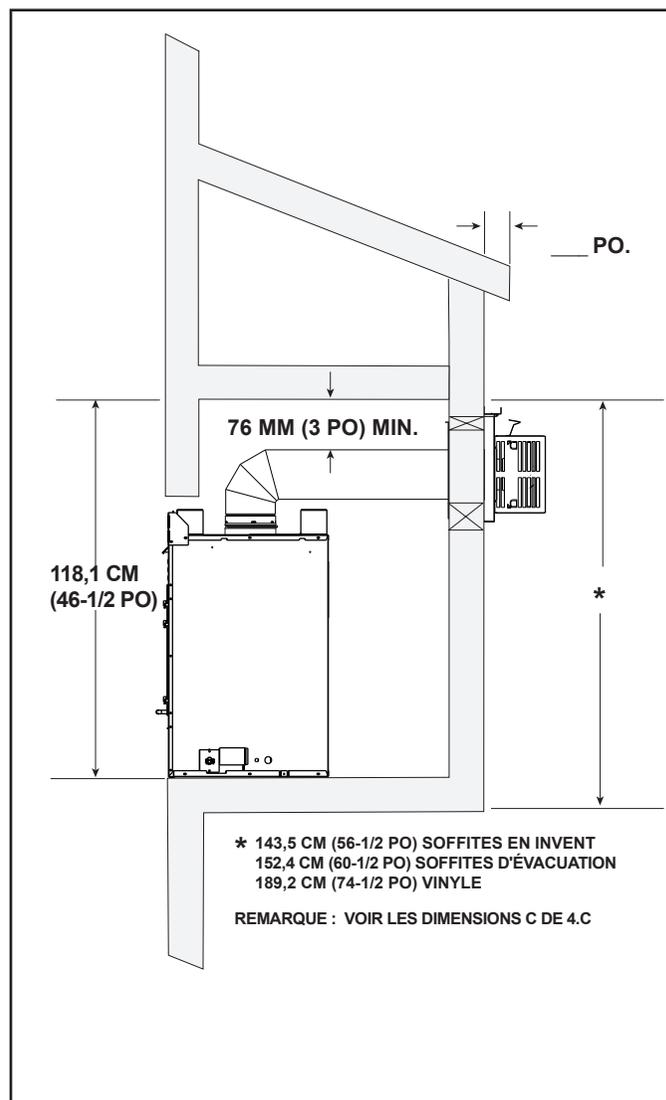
Enchâssure extérieure – Exigences minimales de hauteur
